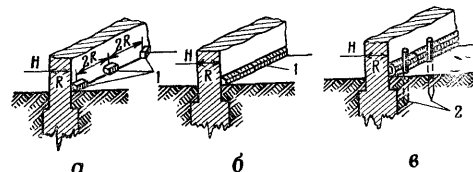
Подрывание бескаркасных стен наружными зарядами:
